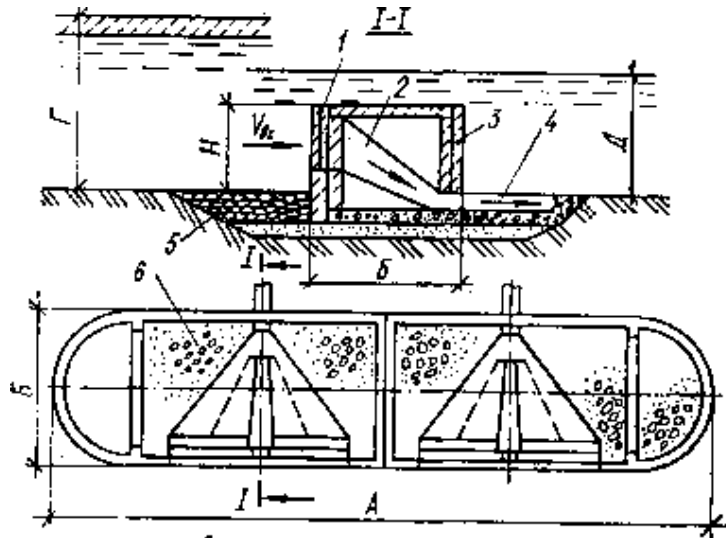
Залізобетонний розтрубний захищений оголовок з боковим прийомом
